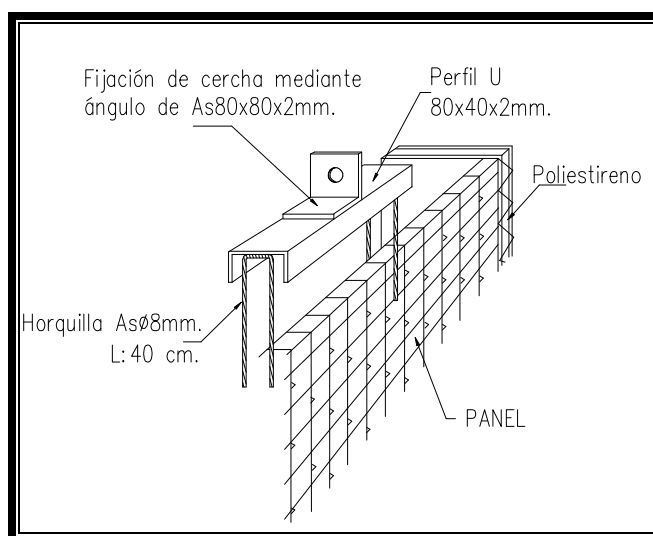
Detalle de fijación de accesorio para unir la techumbre
